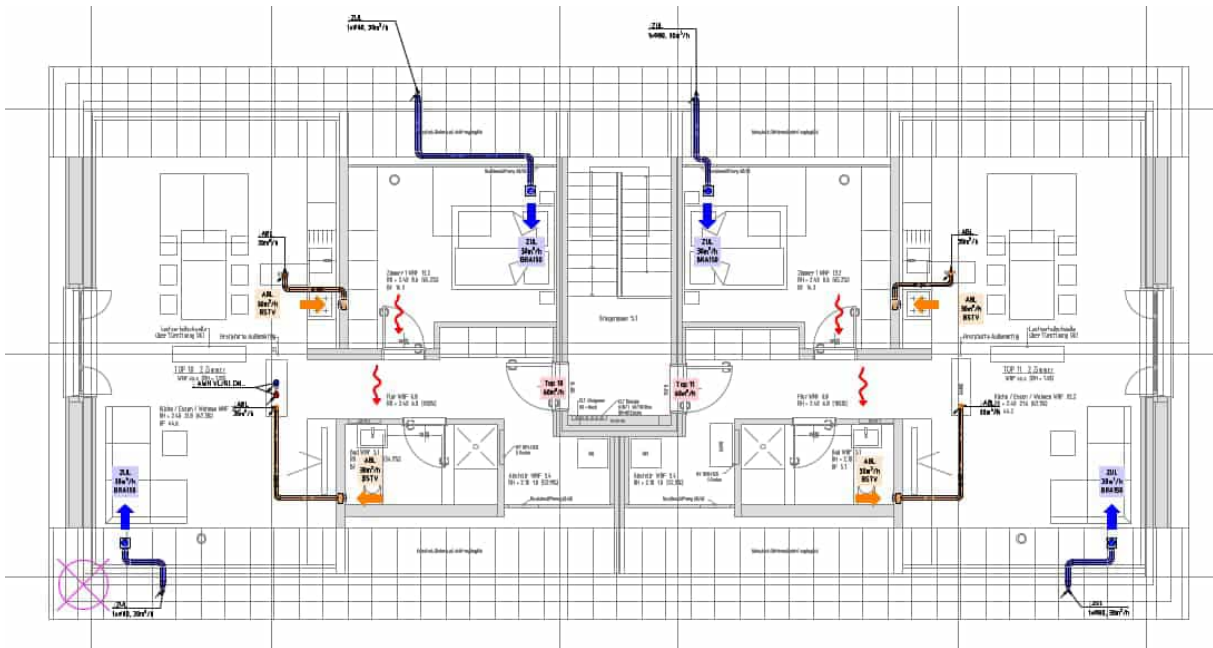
Ausführungsplan Lüftung, DG ; Planungsteam E-Plus
